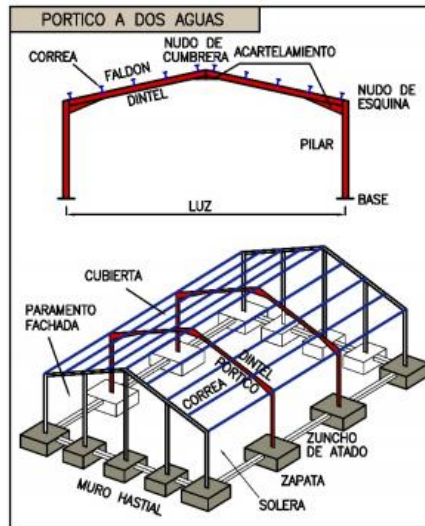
Pórtico. Fuente: apuntes de la asignatura, estructuras metálicas.
